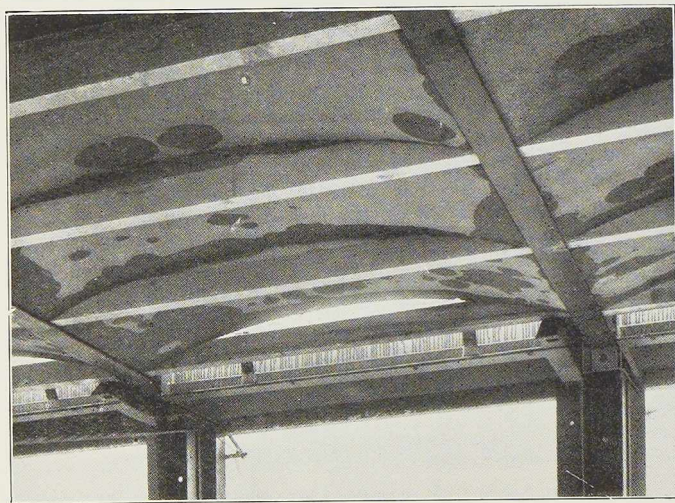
Construction des hourdis en voustettes. On voit les lattes transversales qui porteront le plafond.
